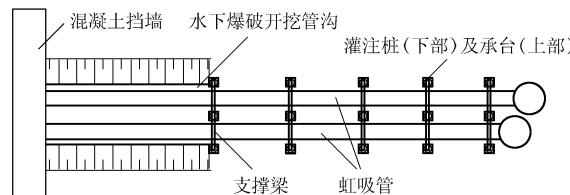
贵阳市西郊水厂虹吸管水下施工平面示意图
